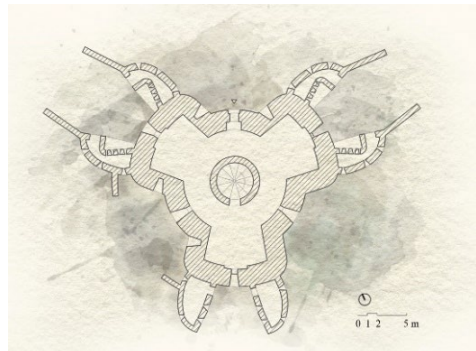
Carloforte, Forte di San Vittorio, pianta del piano terra (elaborazione grafica di Elisa Alberta Bianchi, 2024).
